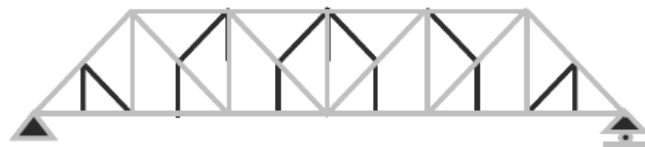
Jembatan Rangka Tipe *Non Paralel Chord* (*Parker Truss*)
